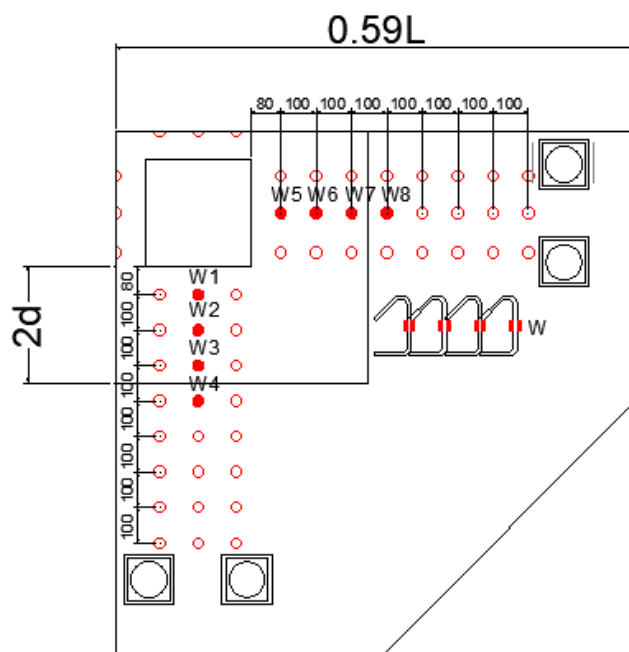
Extensômetros de cisalhamento das Laje ST0 e ST100 (Autora, 2023).
